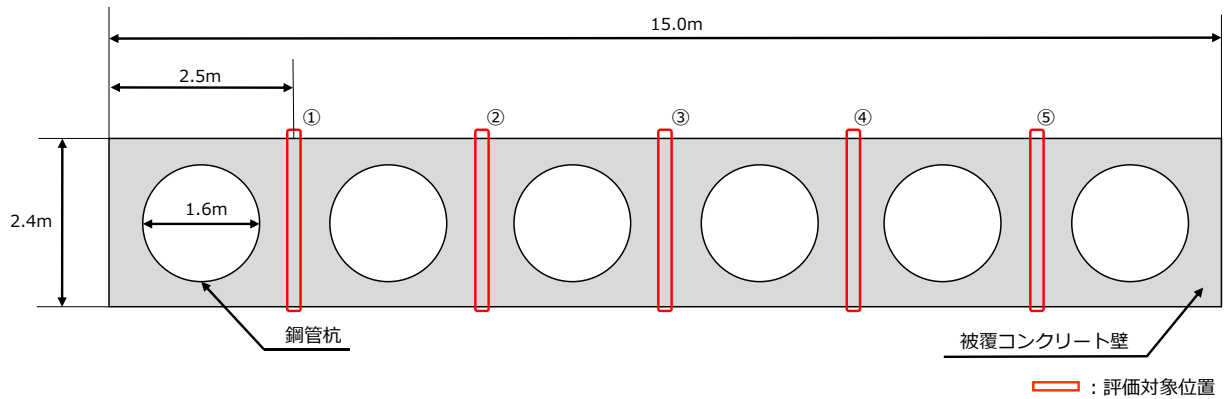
(1) 評価対象位置図 (②-②断面 平面図)
